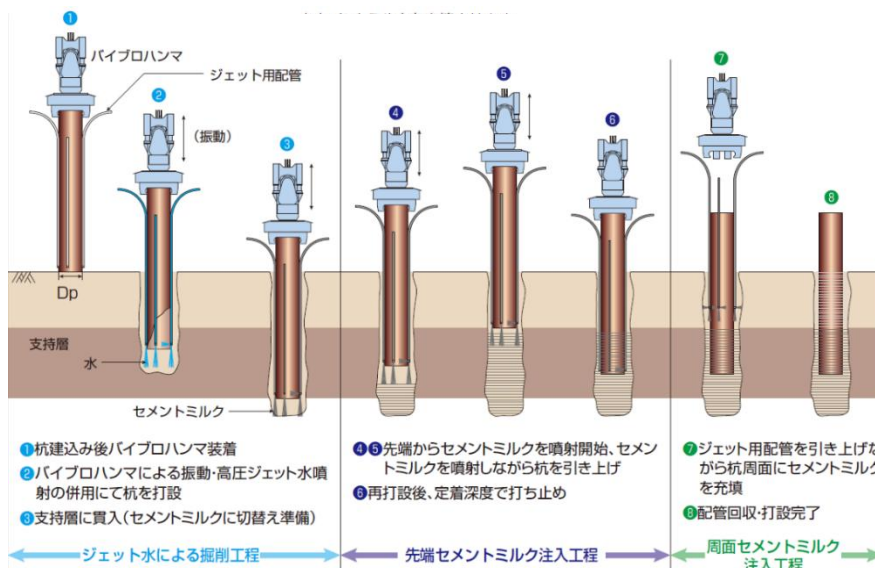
施工手順図 (出典 [5.10-27](#))
